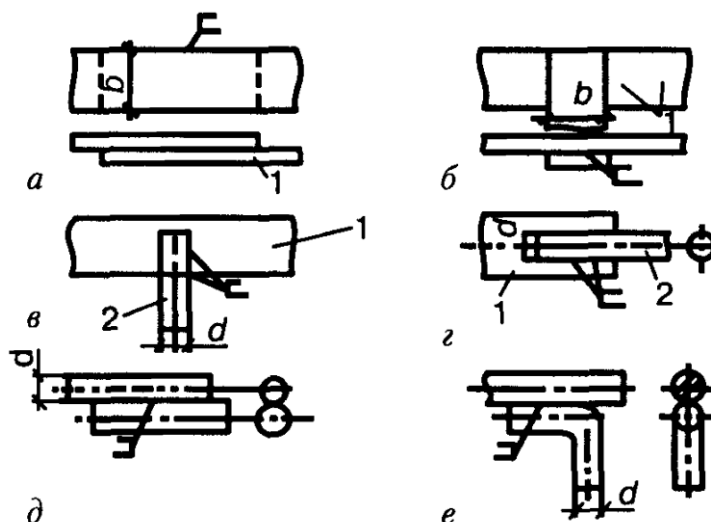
Соединение заземляющих проводников с горизонтальными заземлителями: а) - продольное соединение проводников из полосовой стали; б) – ответвление проводника из полосовой стали; в) - ответвление проводника из круглой стали; г) - продольное соединение проводников из полосовой и круглой стали: д) - продольное соединение проводников из круглой стали; е) – ответвление проводника из круглой стали: 1 - стальная полоса, 2 - сталь круглая
